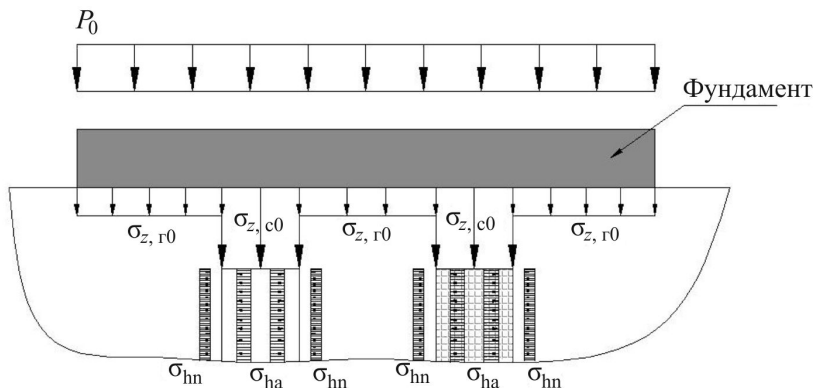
Расчетная схема определения осадки столбчатого фундамента на улучшенном основании: $\sigma_{z,r0}$ – вертикальные сжимающие напряжения в слабом грунте межсвайного пространства в уровне подошвы фундамента; $\sigma_{z,c0}$ – вертикальные сжимающие напряжения в теле грунтовых свай в уровне подошвы фундамента; σ_{hn} – пассивное боковое давление окружающего грунта; σ_{ha} – активное давление грунта в теле свай
